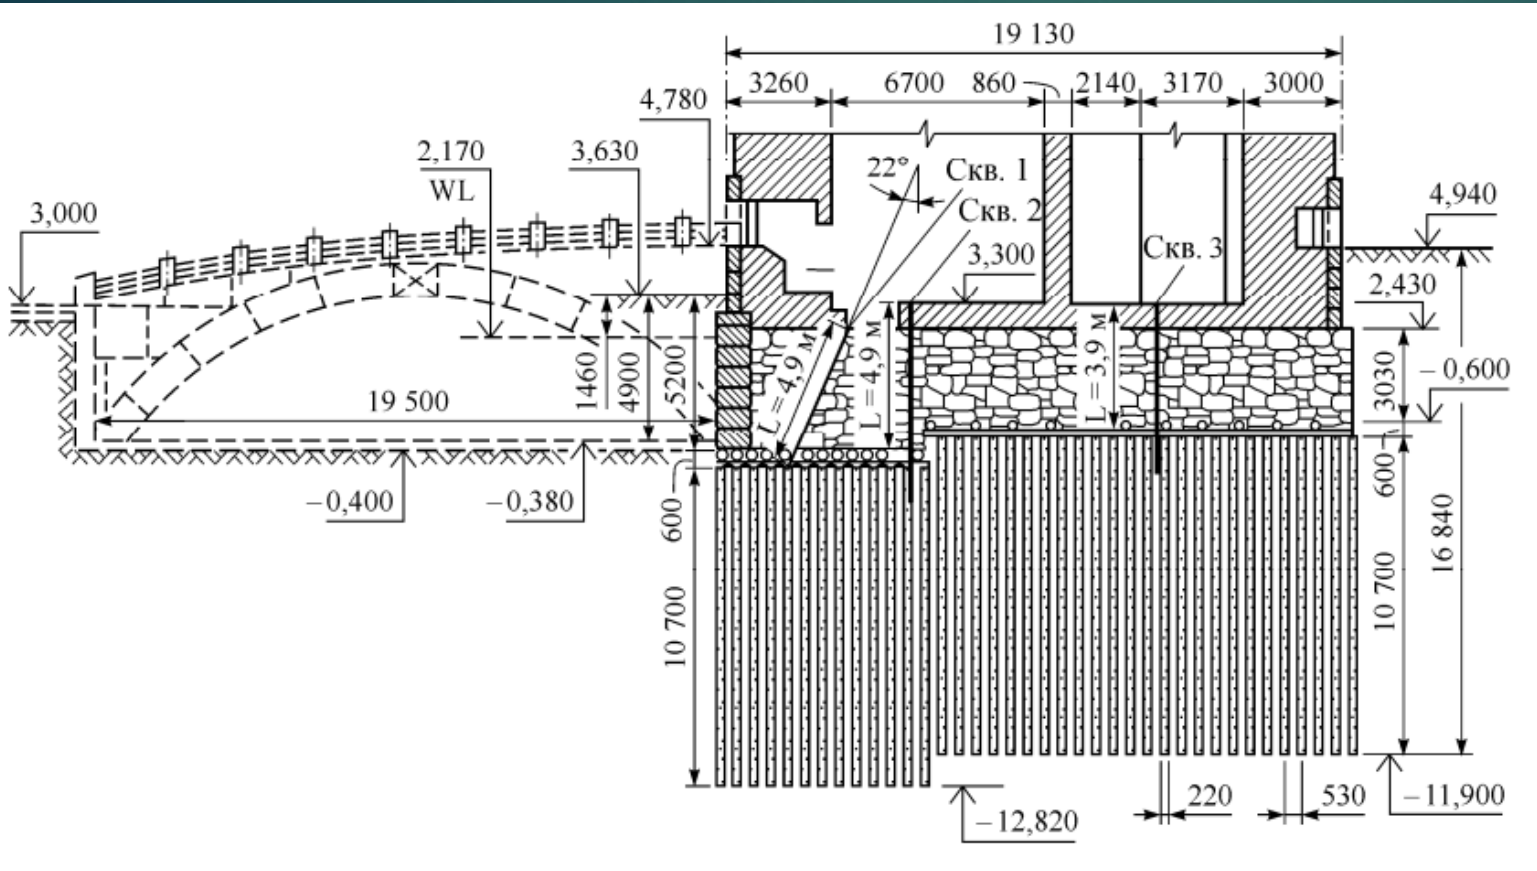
План подвала южного фасада Михайловского замка с геологическими выработками
